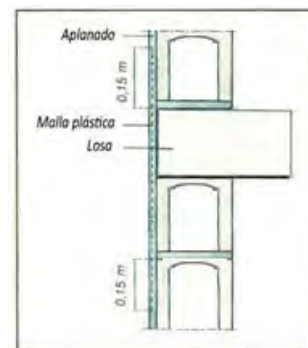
REFUERZO DE MALLA PLÁSTICA EN INTERFAZ DE MAMPOSTERÍAS CON BORDES DE LOSAS
